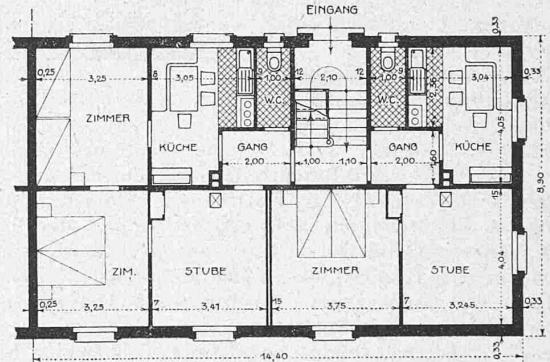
Grundriss eines Flügel-Hauses. — 1:200.
